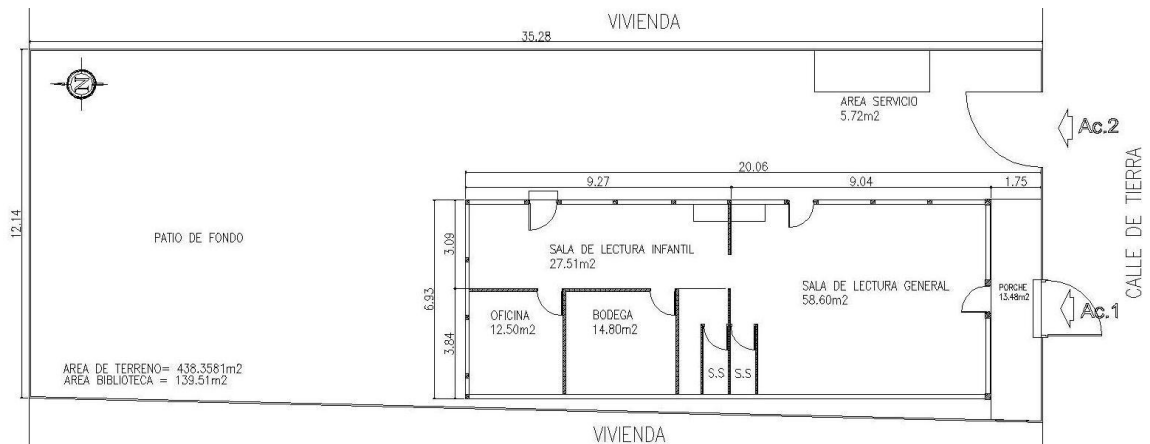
Planta de conjunto de la Biblioteca Ajax Delgado.
